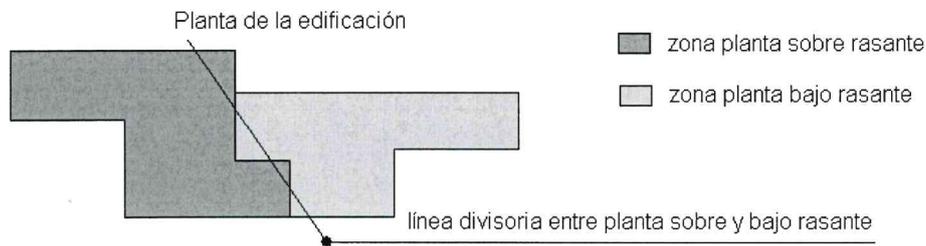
Reparto superficial equivalente siguiendo divisorias características de la edificación entre la zona considerada planta sobre rasante y planta bajo rasante.
